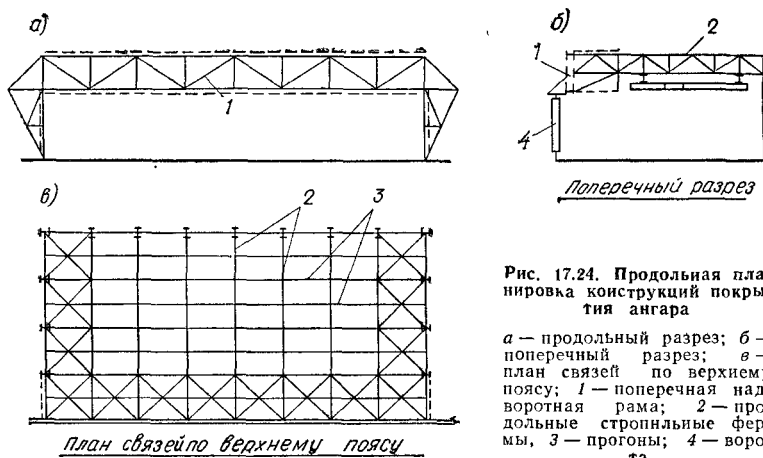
Продольная планировка конструкций покрытия ангара
